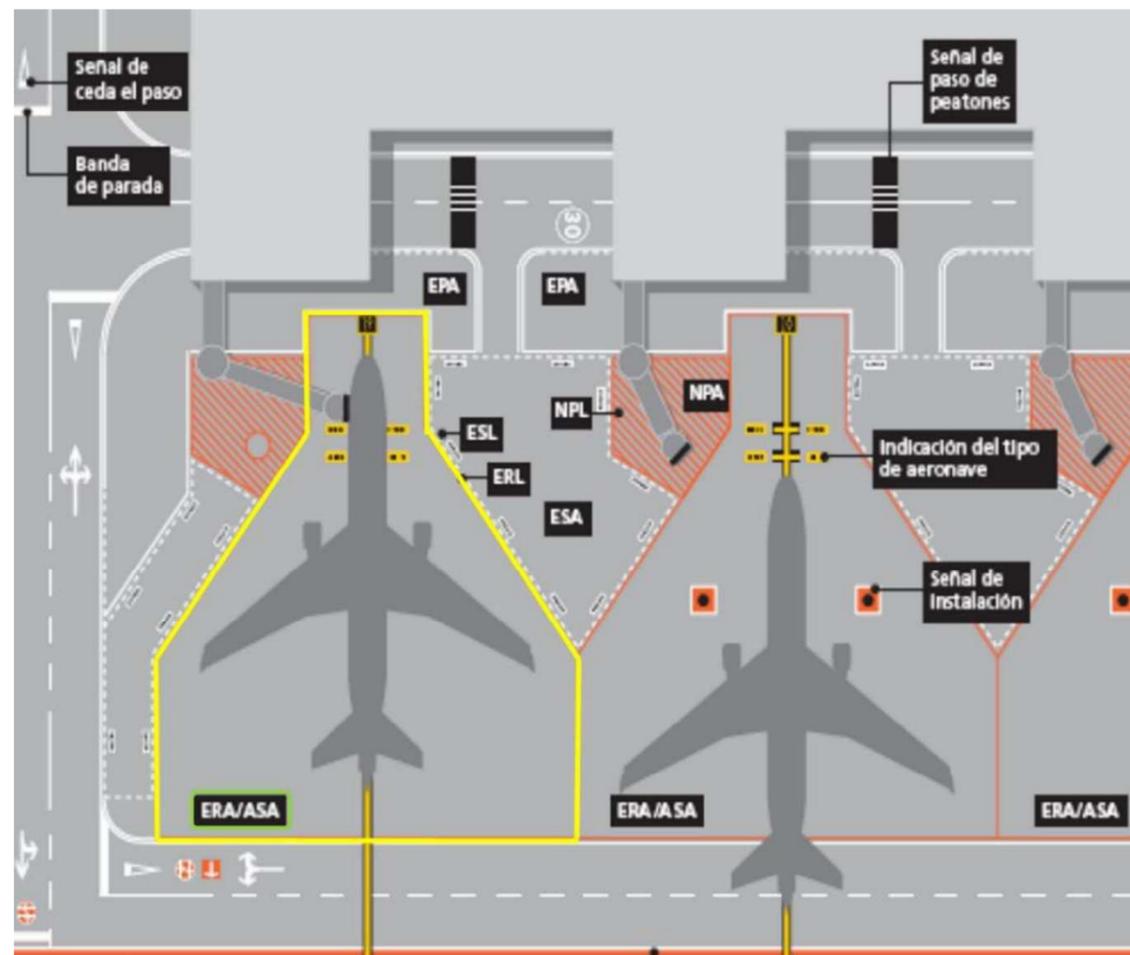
Zonas de Restricción y Seguridad ERA/ASA (Franja amarilla).
